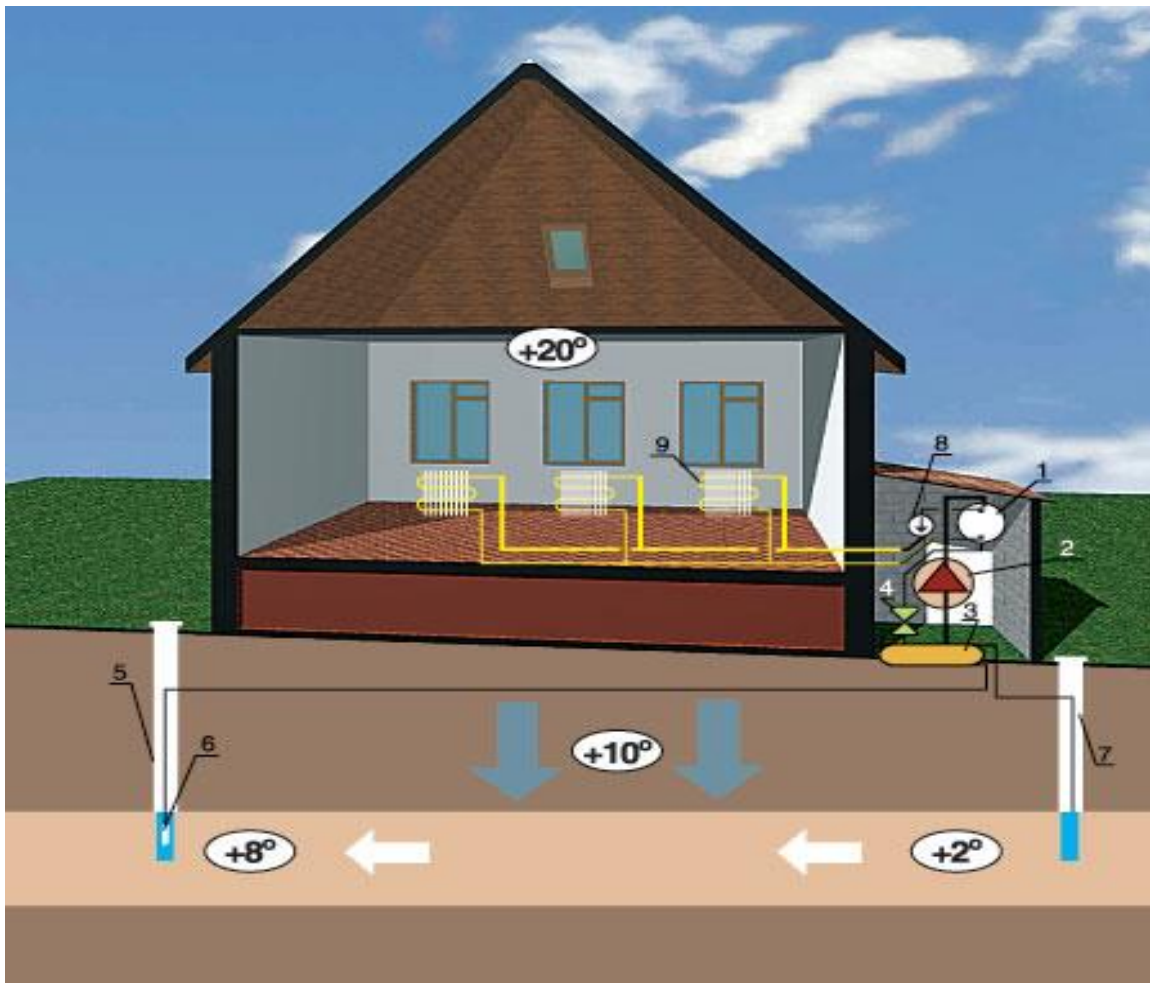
Схема теплового насоса на основі ґрунтової води для системи водяного опалення
